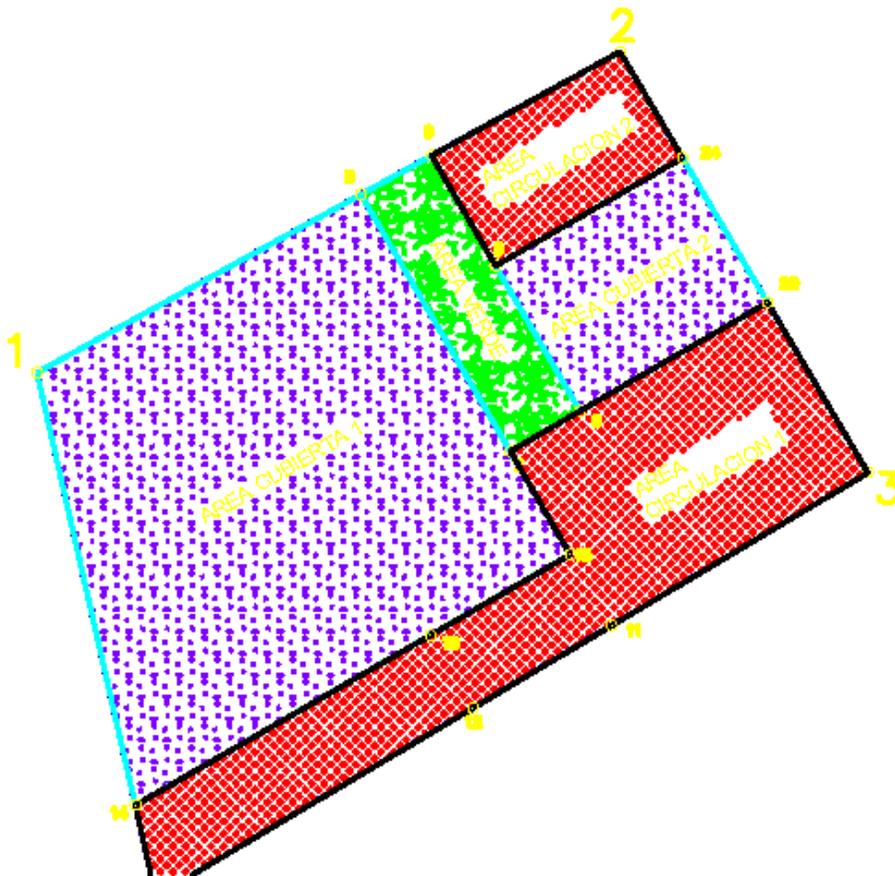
Plano con los polígonos que engloban los conceptos de obra del proyecto.
